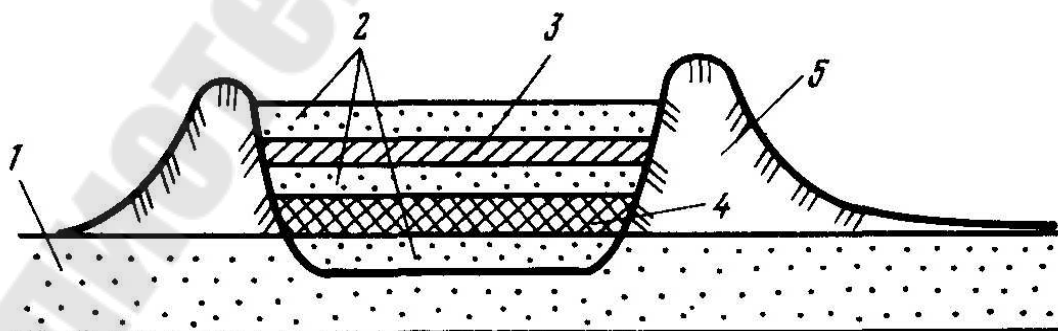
Конструкция дренажной фильтрующей площадки: 1 – дренажный минеральный грунт; 2 – песчаный слой; 3 – слой извести; 4 – слой ионитовой крошки; 5 – обваловка
